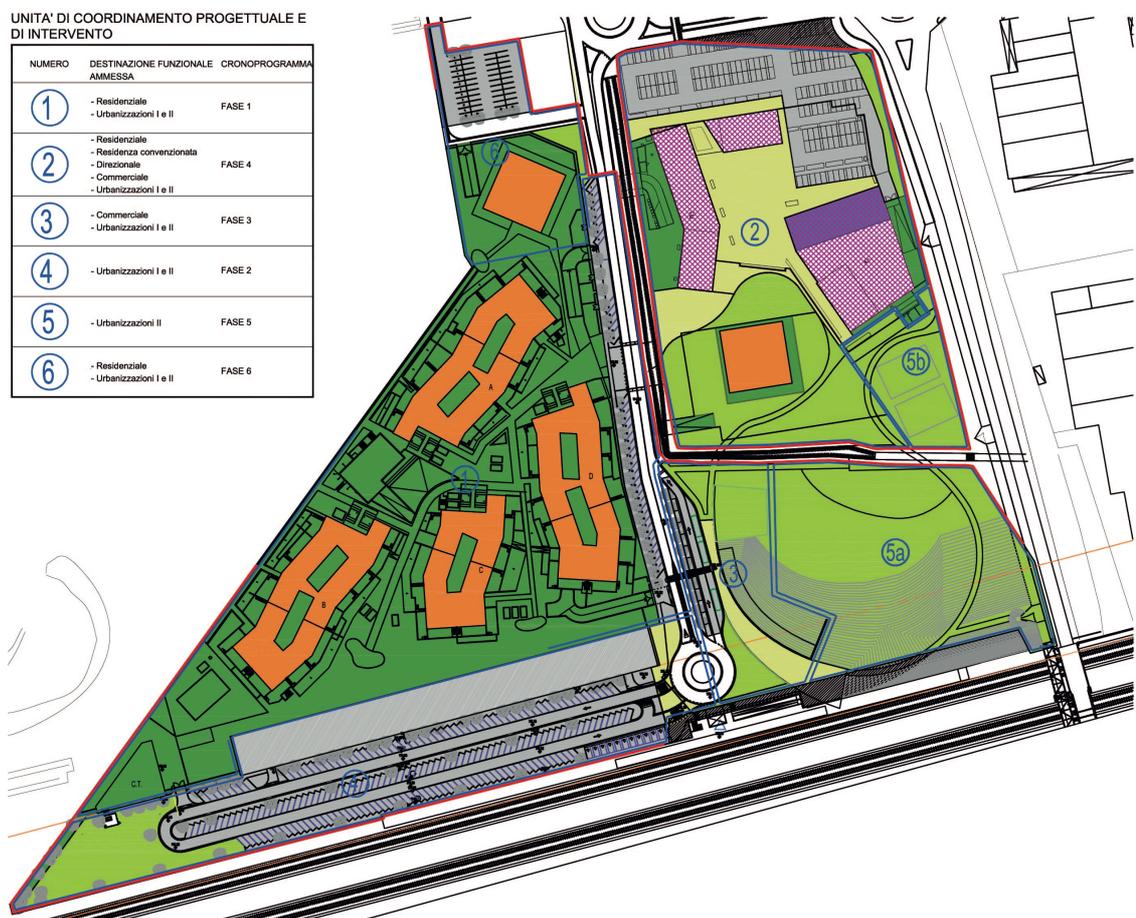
| Estratto della Tavola 4.4 allegata alla modifica planivolumetrica al P.I.I. approvato a marzo 2012.
